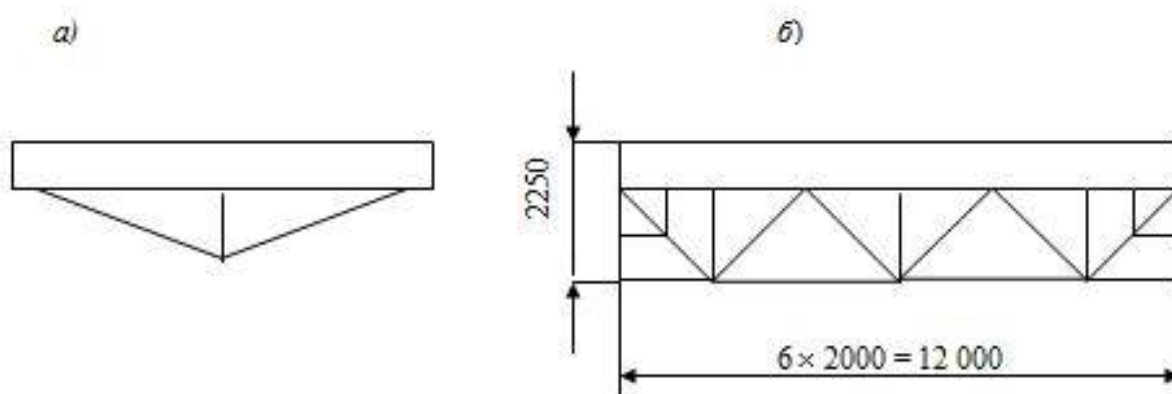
Схемы подкрановых балок, усиленных: а) – шпренгелем; б) – сквозной фермой
